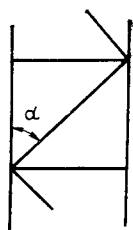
Схема для определения угла наклона раскоса соединительной решетки
